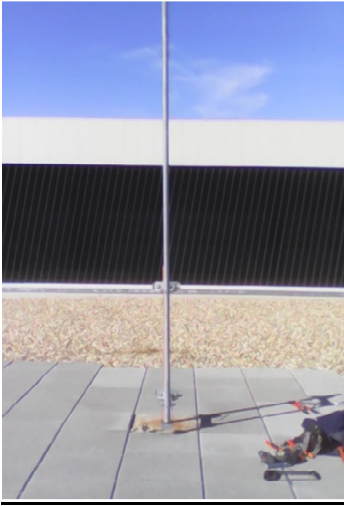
REPARACION GRIETA Y TESTIGOS.
